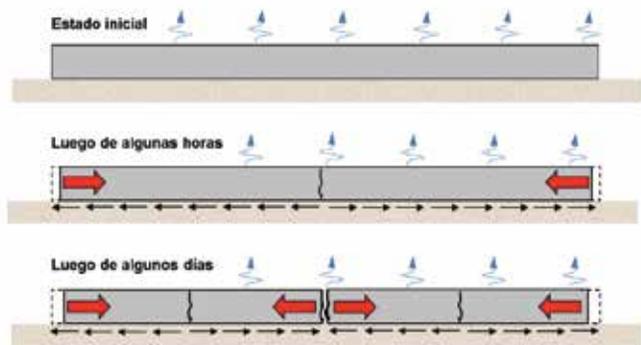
efecto de la contracción y restricción sobre la fisuración temprana de los pavimentos de hormigón simple (Becker, E., 2014)[1].
